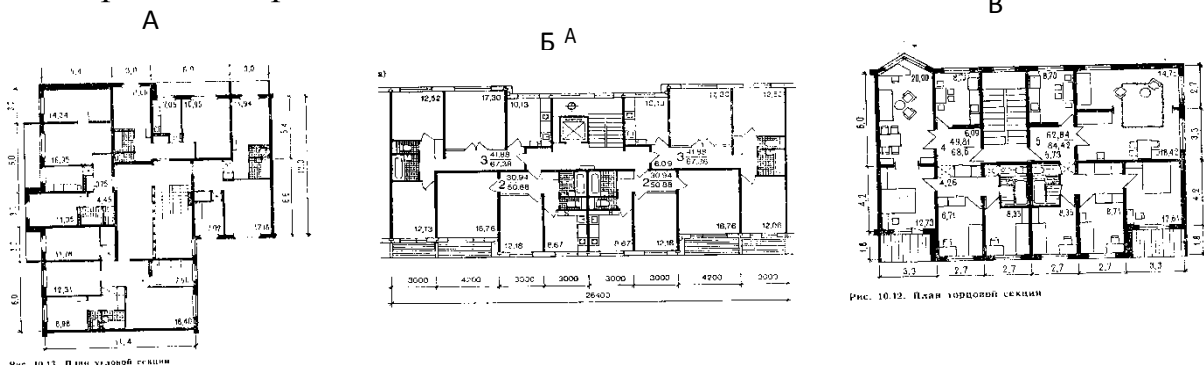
Схемы планировочных решений секций жилого дома: А – угловая, Б – рядовая, В – торцевая.
